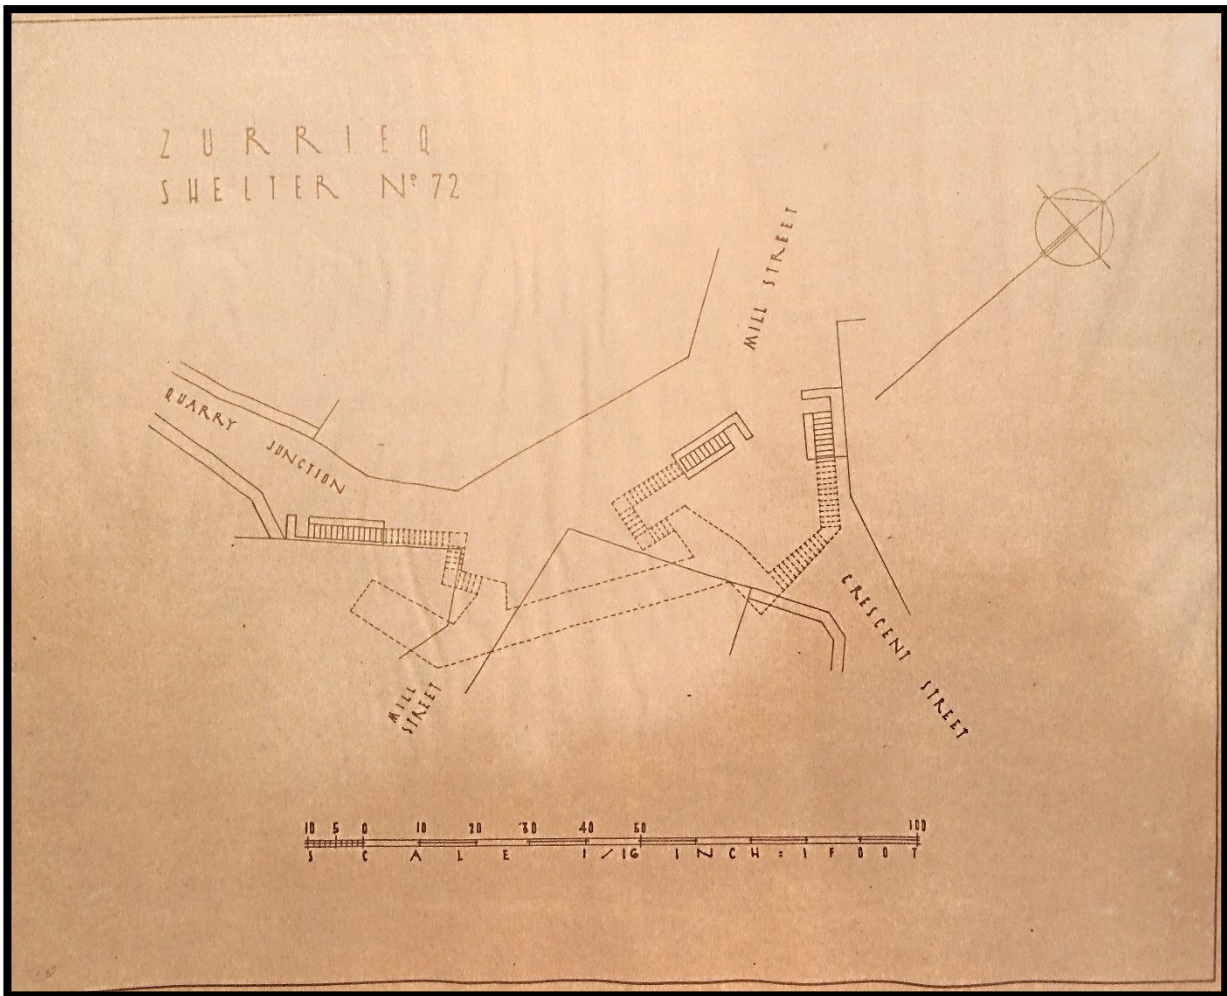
Planta do Abrigo nº72 "Ruarry Junction – Mill Street* – Crescent Street."
